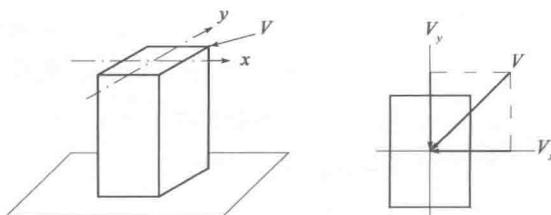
斜向水平荷载作用下钢筋混凝土框架柱的受剪
